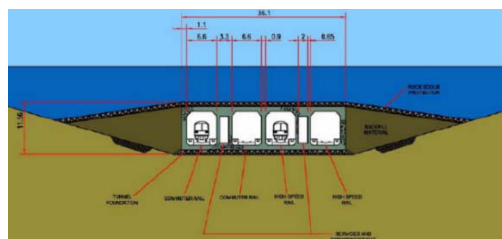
Secção Tipo em Túnel: Solução Beato-Montijo [28]
